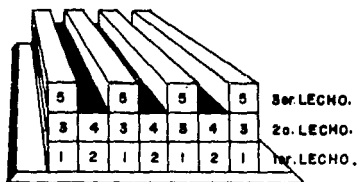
SECUENCIA DE COLADO DE PILOTES DE SECCION CUADRADA.
